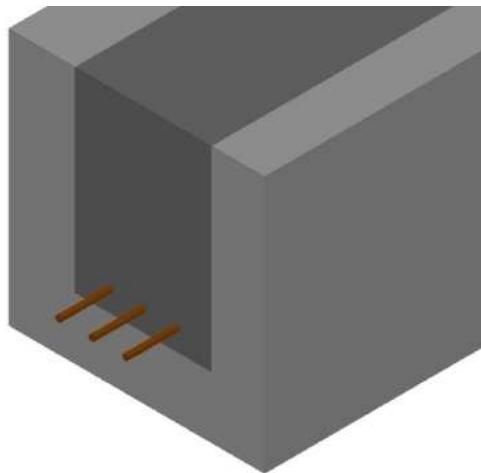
Secção de cálculo estrutural (ARGISOL, 2010).
